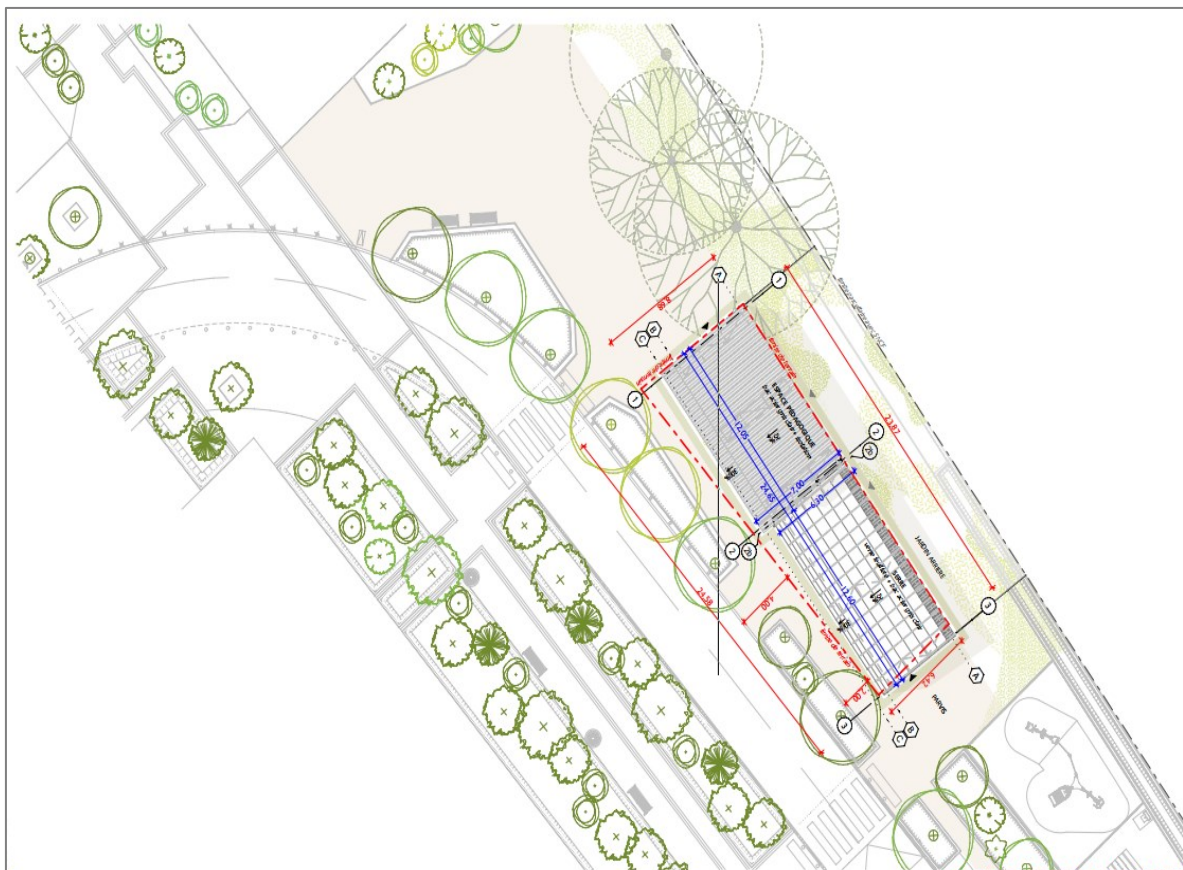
Plan de masse (Source : maitrise d'œuvre)
